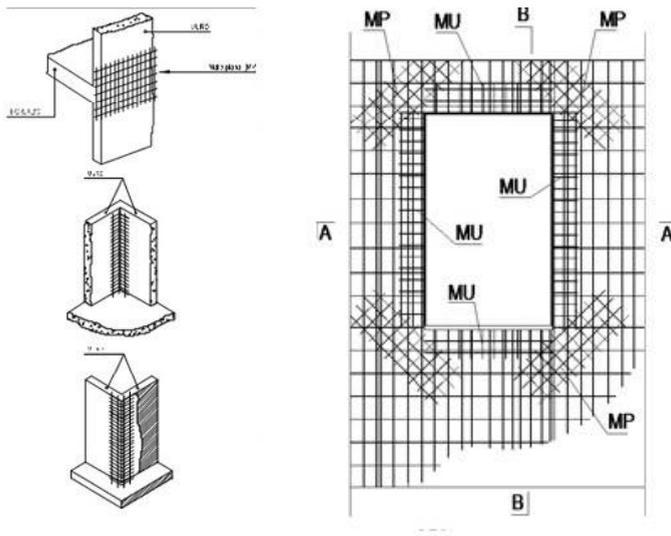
Tipos de refuerzos del sistema Baupanel. 20013. Baupanel.
